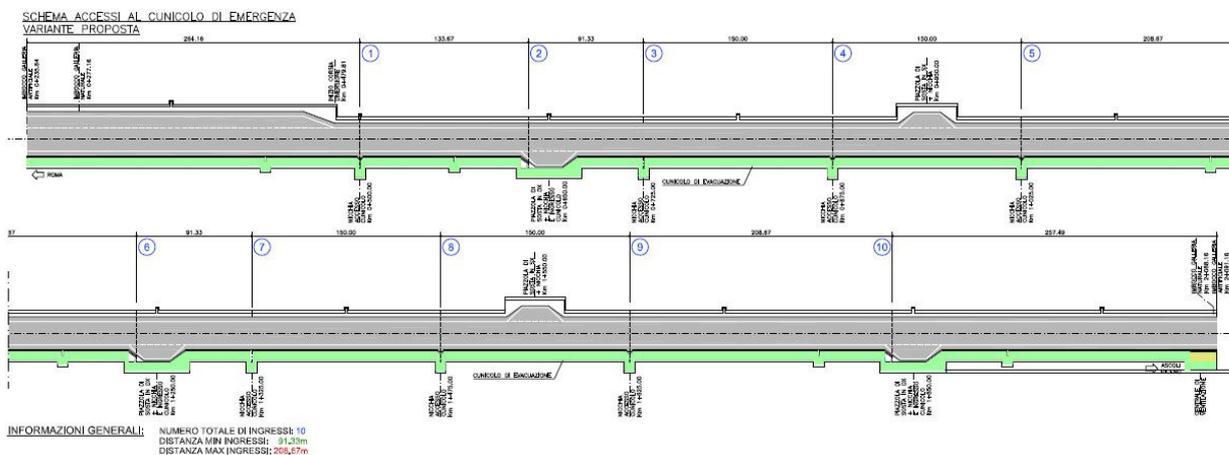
Schema planimetrico con cunicolo di evacuazione (in verde)
